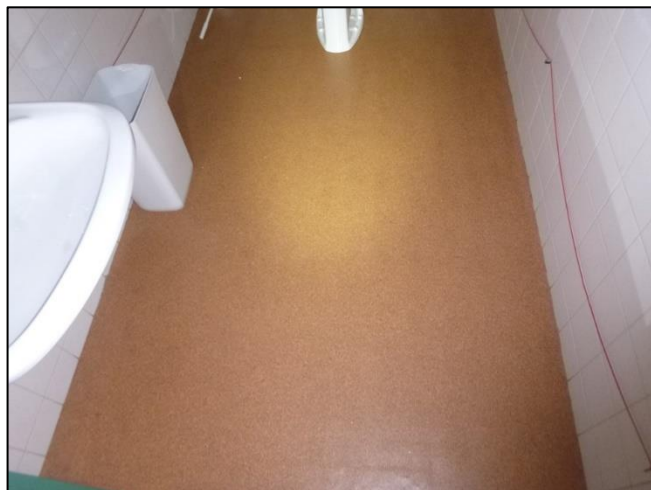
Toilet: Vloerafwerking (Niet asbestverdacht)
